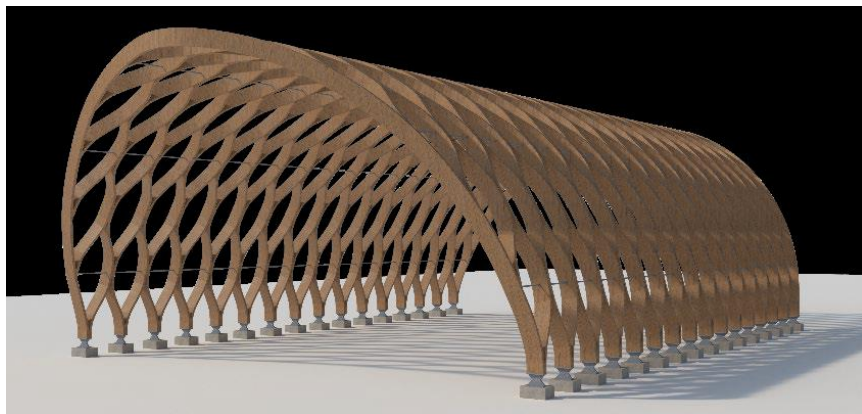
Общий вид каркаса покрытия лаунж-зоны
